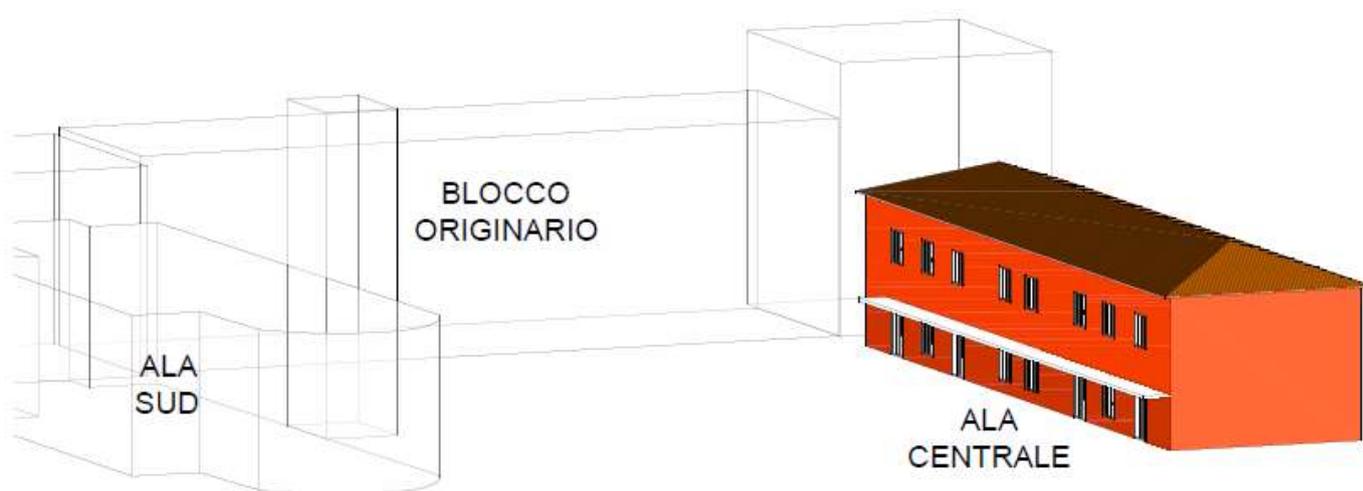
Individuazione della porzione del complesso oggetto d'intervento – vista tridimensionale
